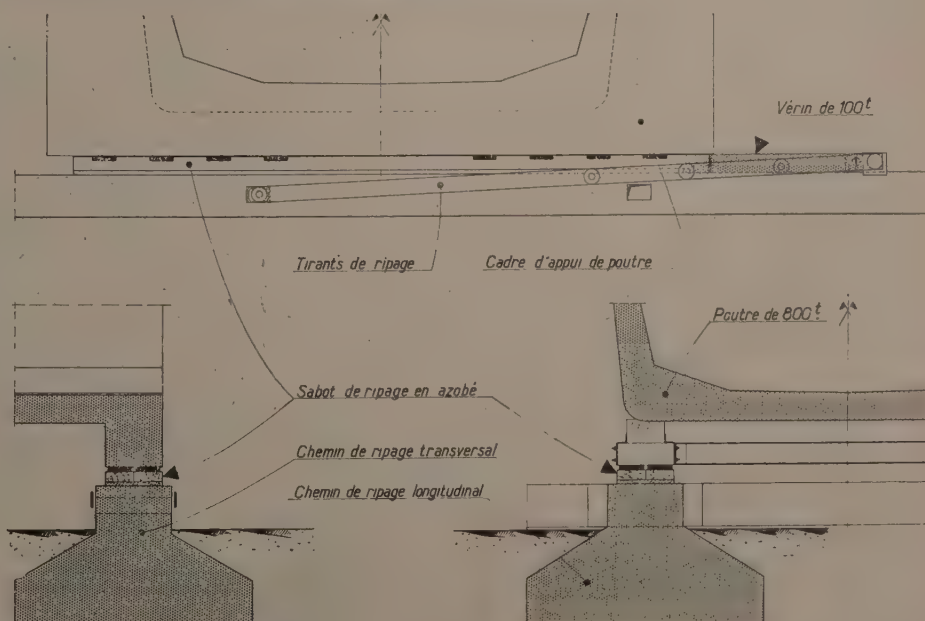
Dispositif de ripage des poutres de 800 t.
